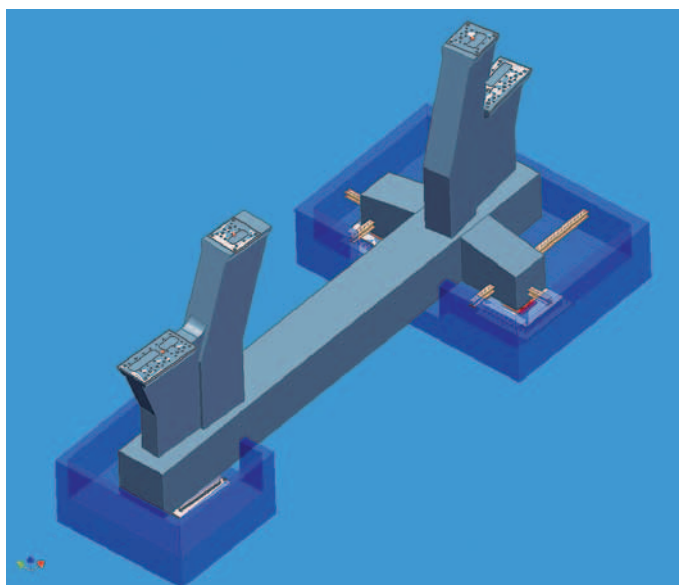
Sistema di appoggio tripode della stazione intermedia di un impianto a fune con sostegni, travi a T e bauletti di fondazione (© Leitner AG, PHILLIPS *et al.* 2007).
